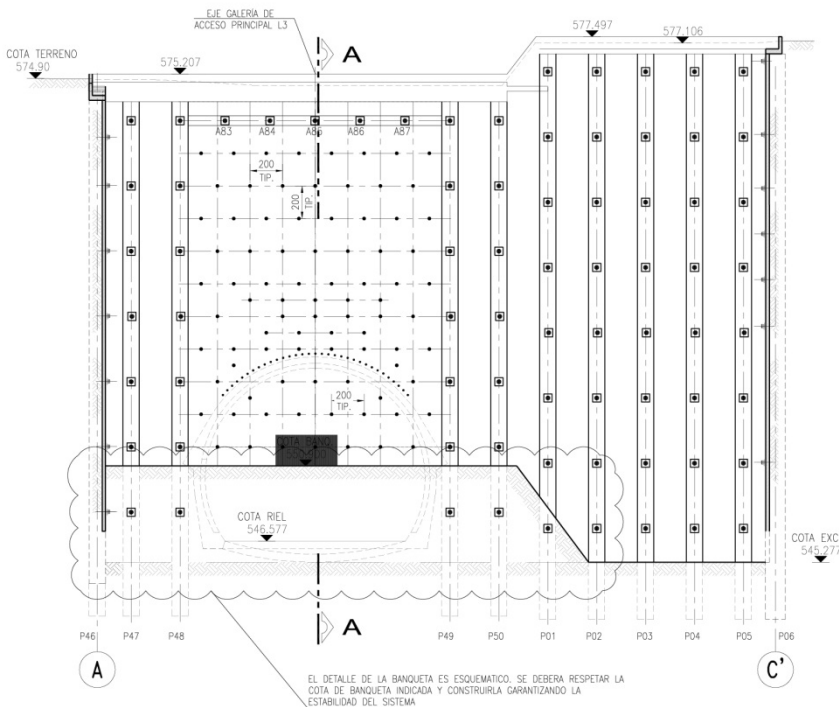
Vista en Corte del Soil Nailing la Estación Estadio Nacional
